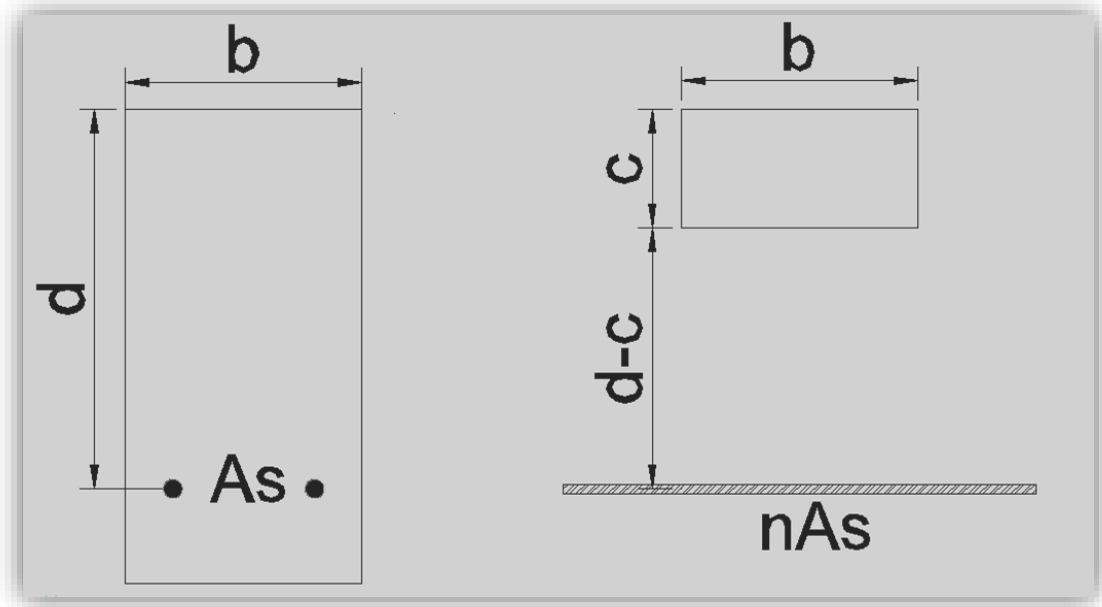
Sección transformada de acero para el caso de la viga en estudio
